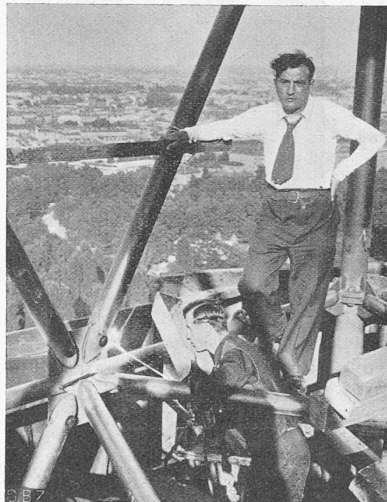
Schweißen eines Knotenpunktes gemäss Abb. 9 oben links. — Entwurf des Turmes: Prof. Dr. Ing. Cesare Chiodi, Mailand.
